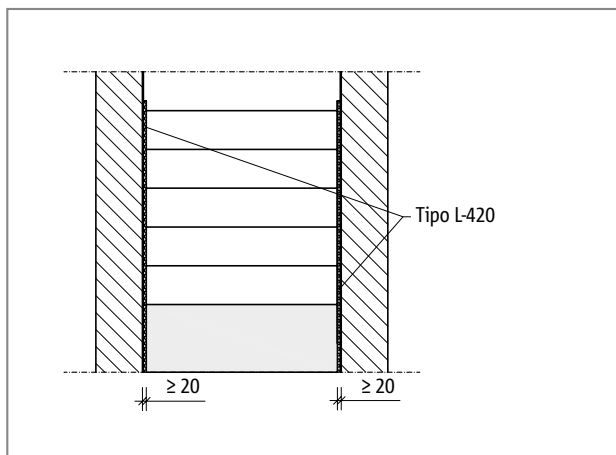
Schöck Tronsole® tipo L-420, tolleranze di montaggio
